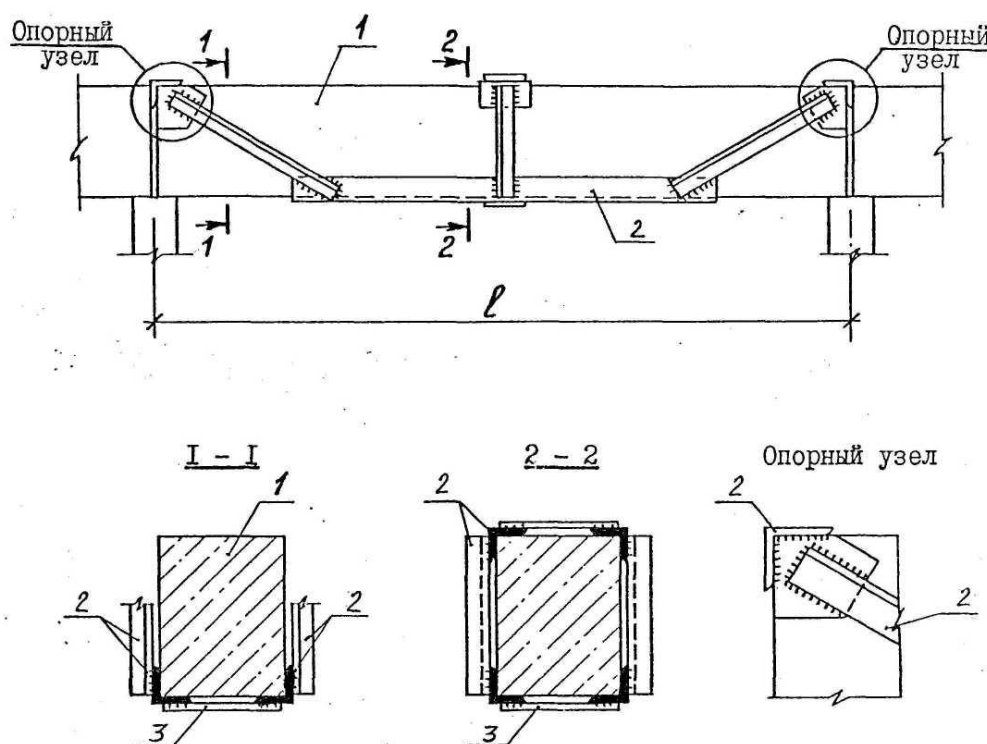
Усиление железобетонной балки стальным шпренгелем.
